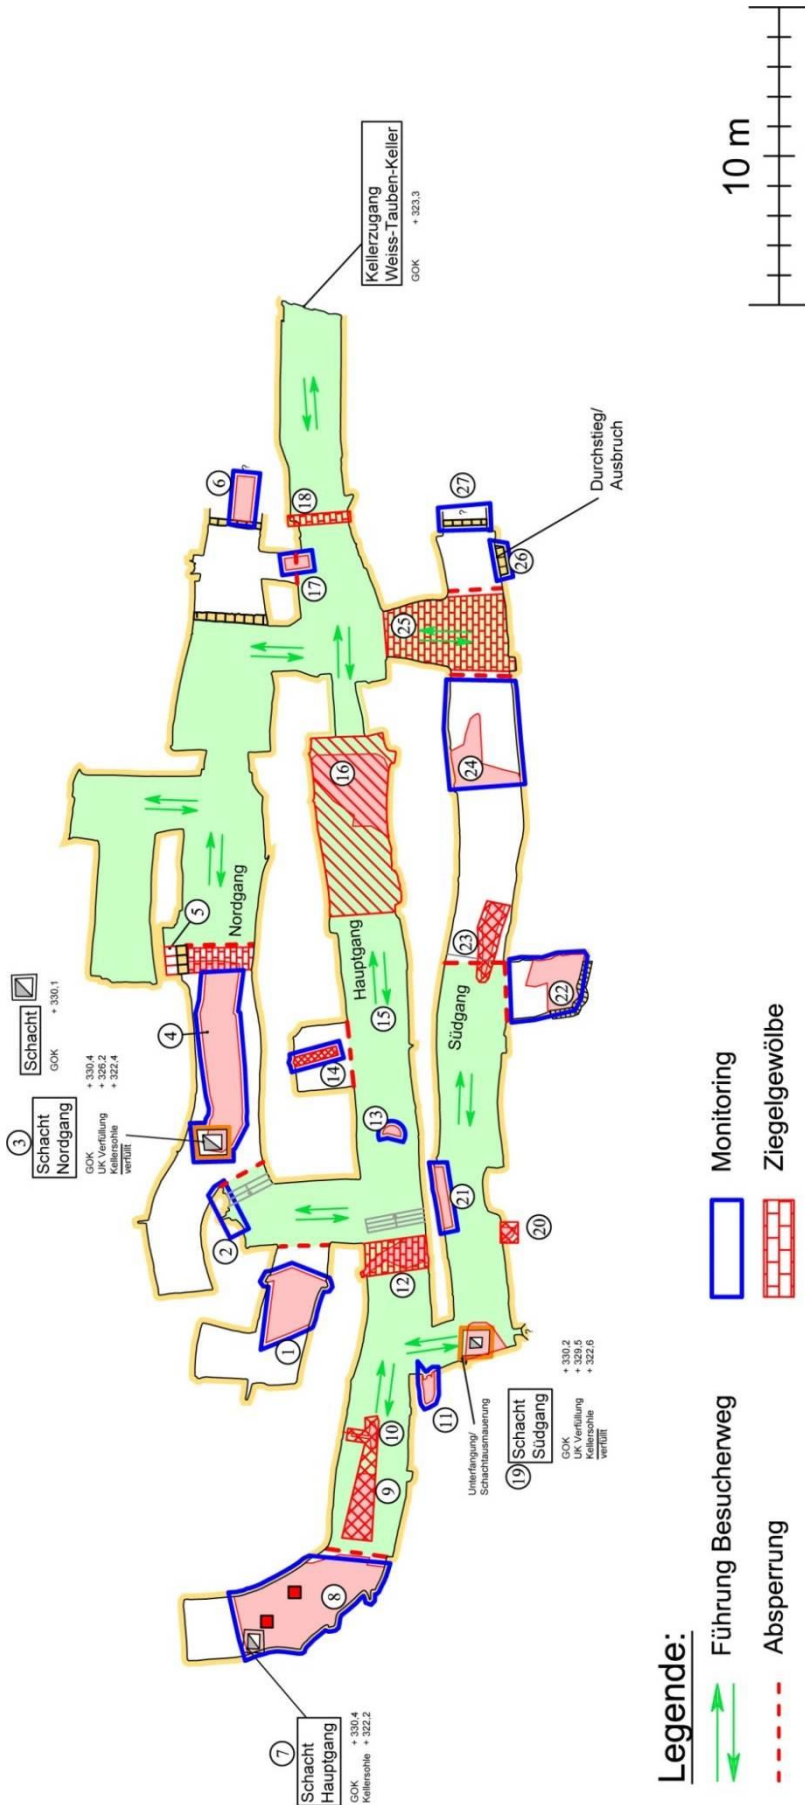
Grundriss zur Nutzung und Sanierung des Weiss-Tauben-Kellers
